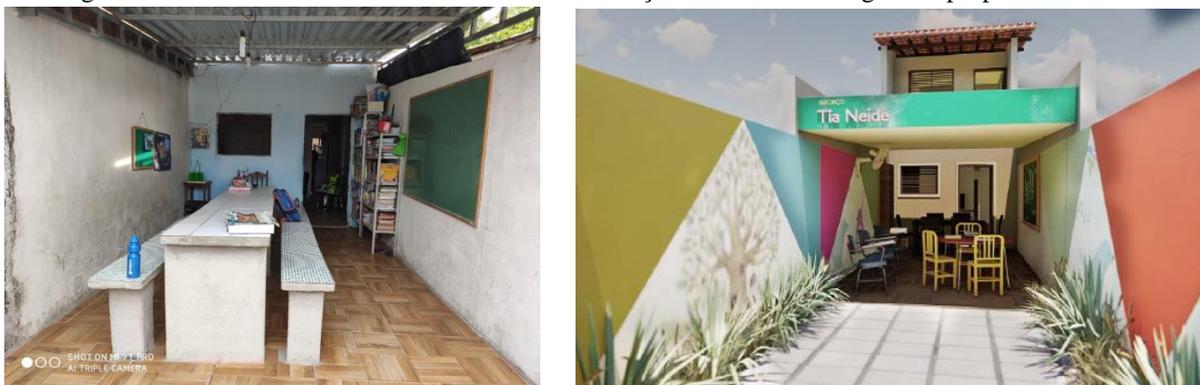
e 16: demolição da mesa de alvenaria e instalação de fôrro.
